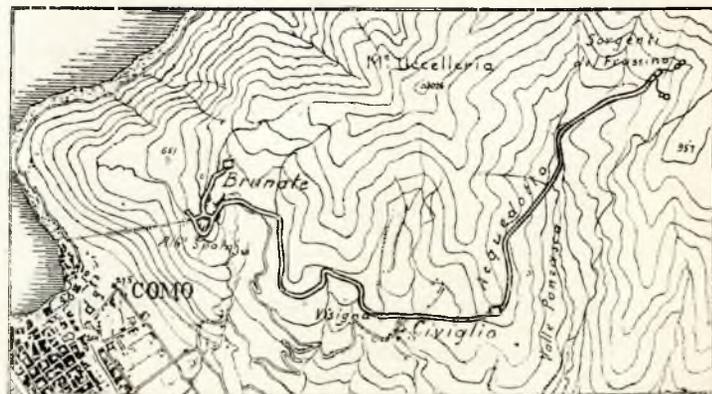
Planimetria generale dell'acquedotto di Brunate..
